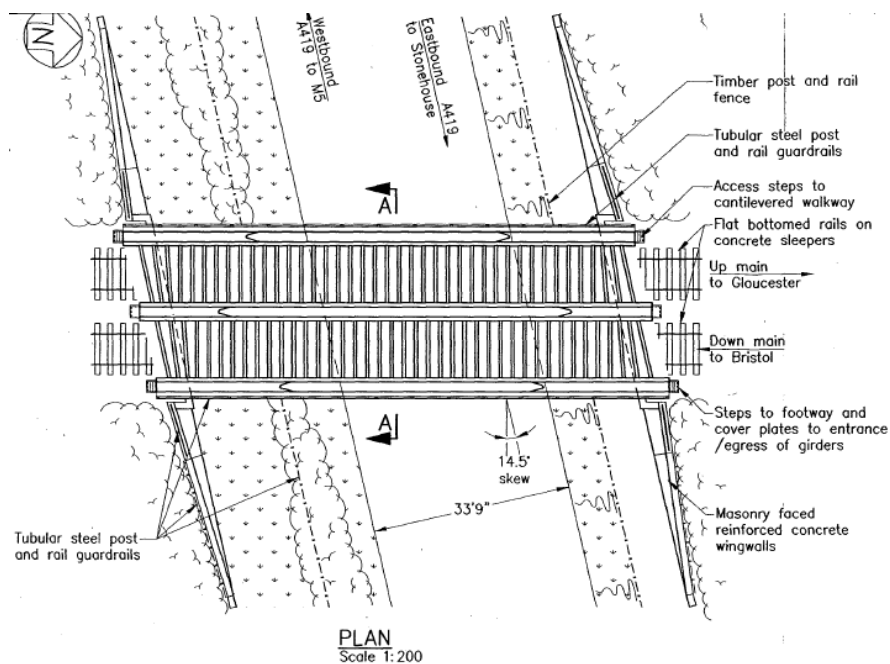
Planta da ponte Bristol, (Shawcross, 2001)
